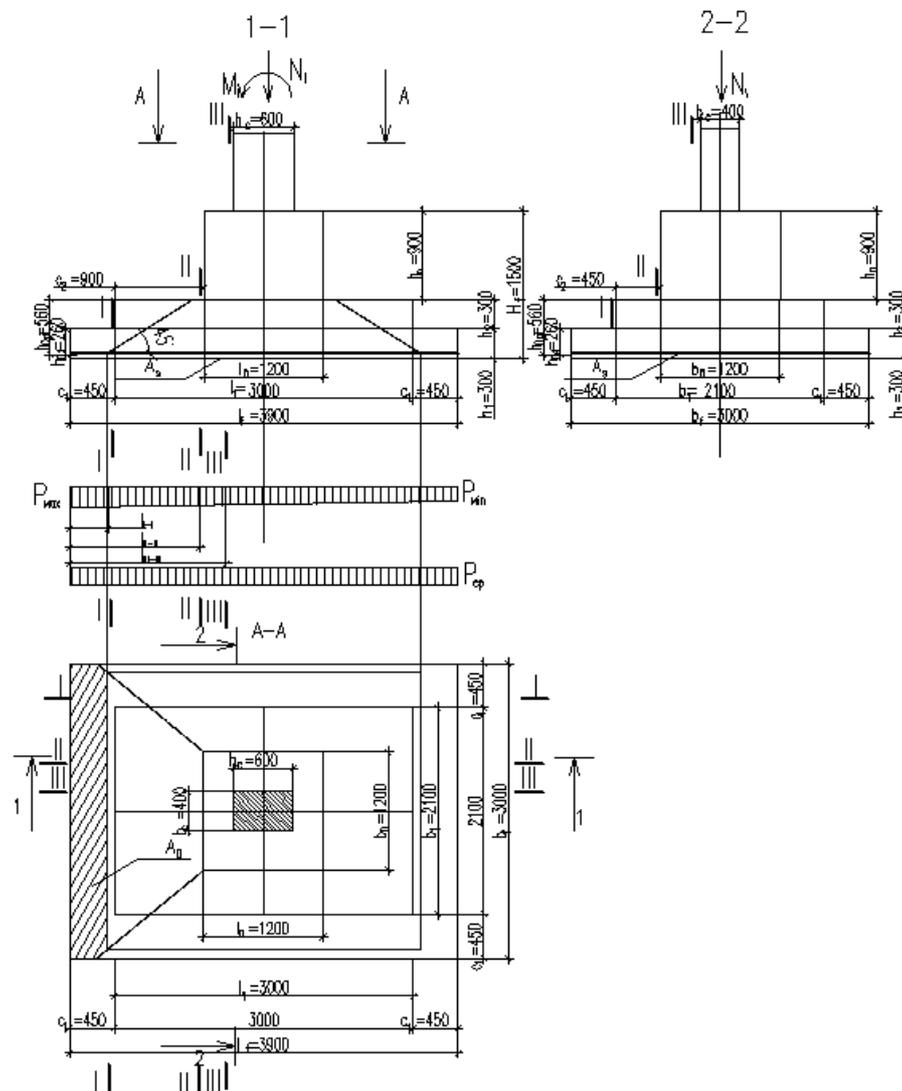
К определению высоты фундамента, конструирование фундамента и к расчету прочности плитной части на продавливание.
